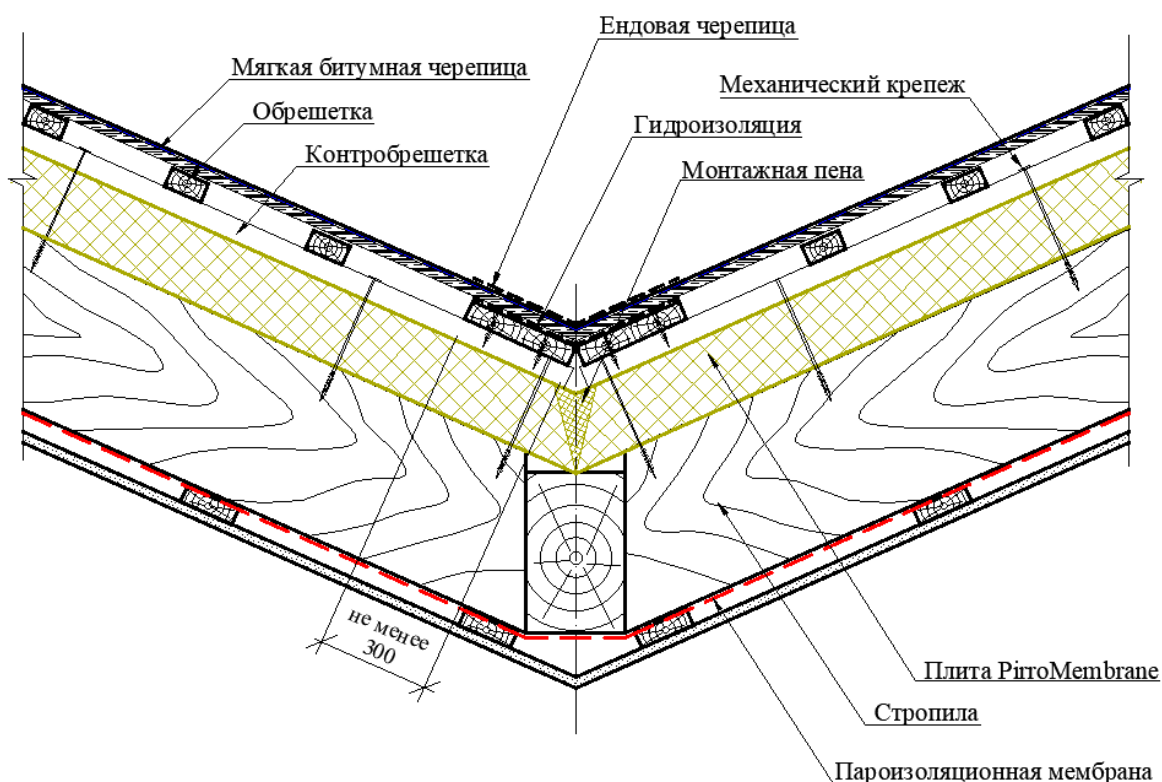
Укладка PIR-плит в зоне ендовы
